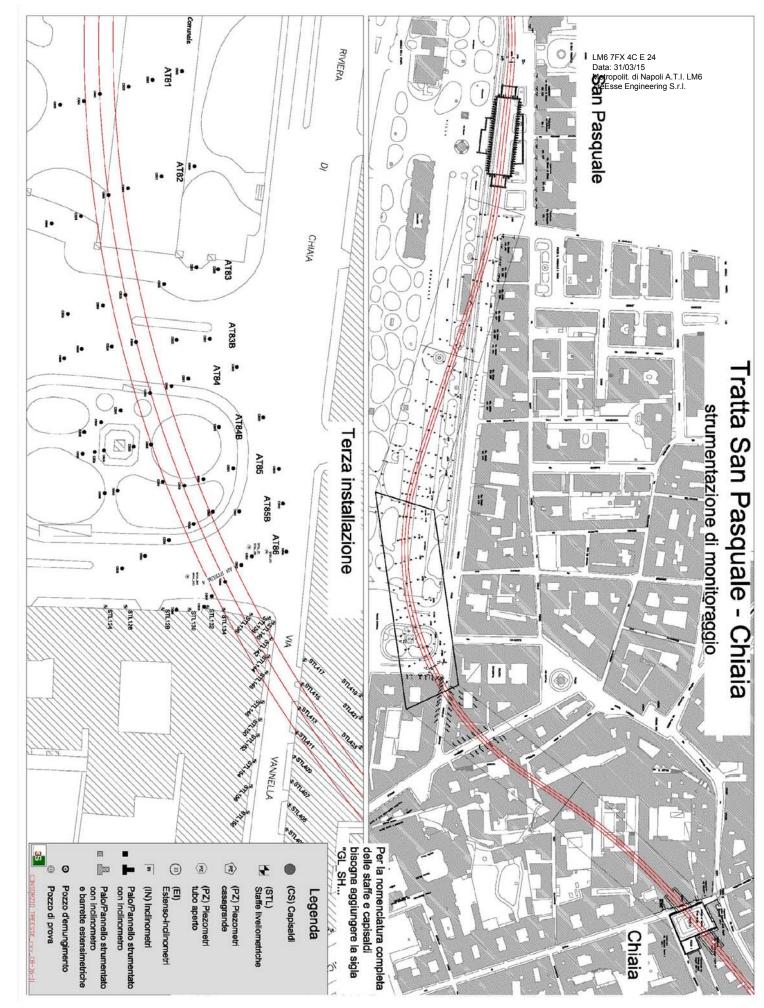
Planimetria tratta San Pasquale - Chiaia, raffigurante la disposizione della terza installazione della strumentazione di monitoraggio.
